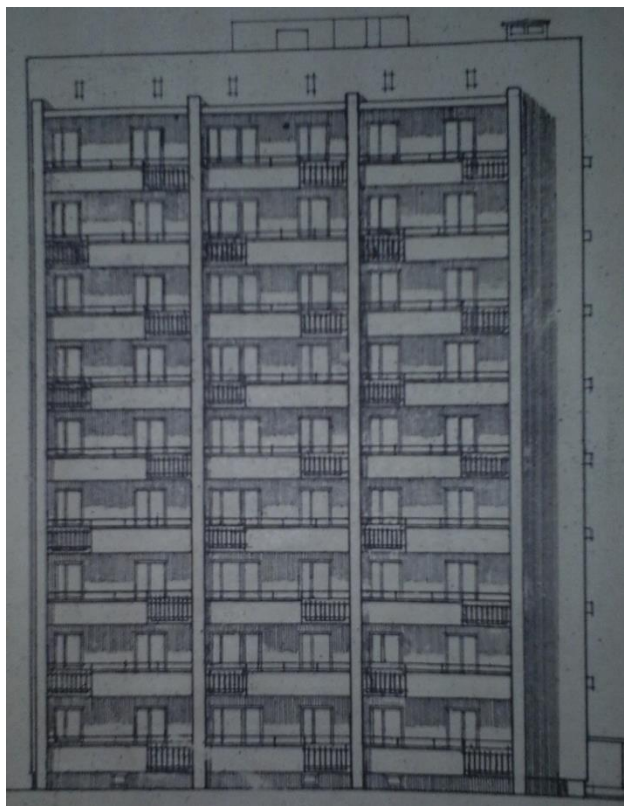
Вариант фасада дома с перекрытиями лоджий на отметках перекрытия квартир
